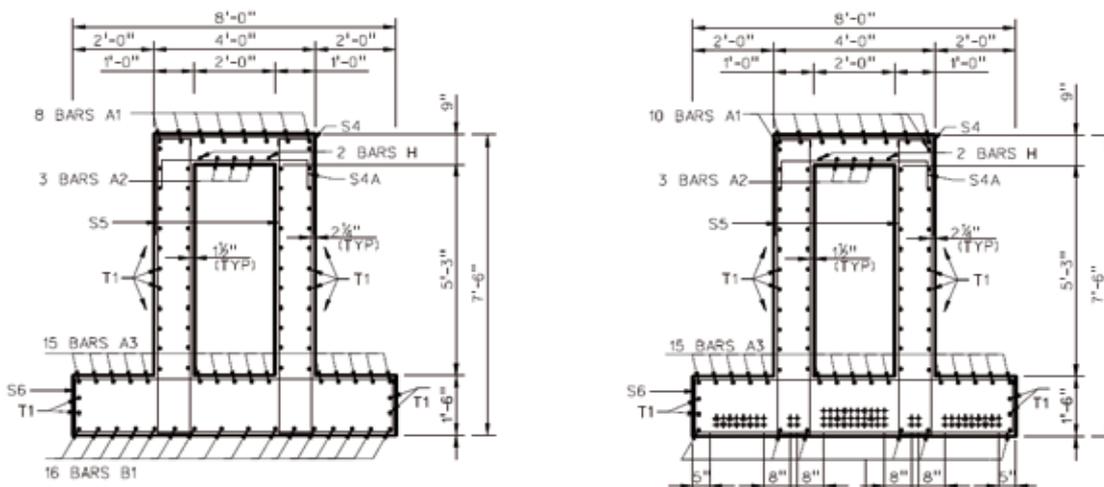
Dinteles prefabricados. Secciones transversales sin armaduras pretensas y con ellas
